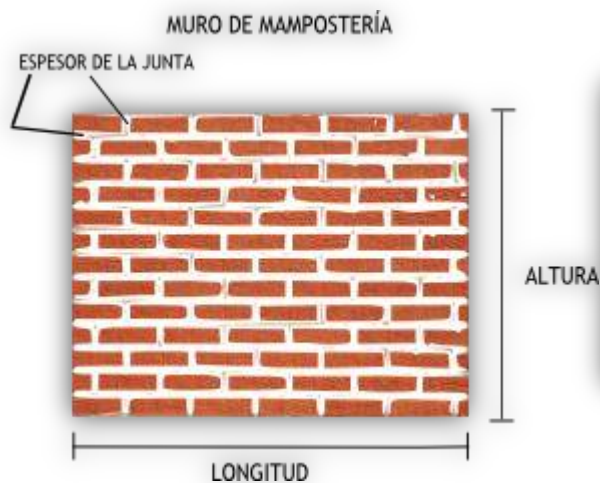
fuente: <http://www.construcalculos.net/CONSTRUCALCULOS-MUROS.php>
